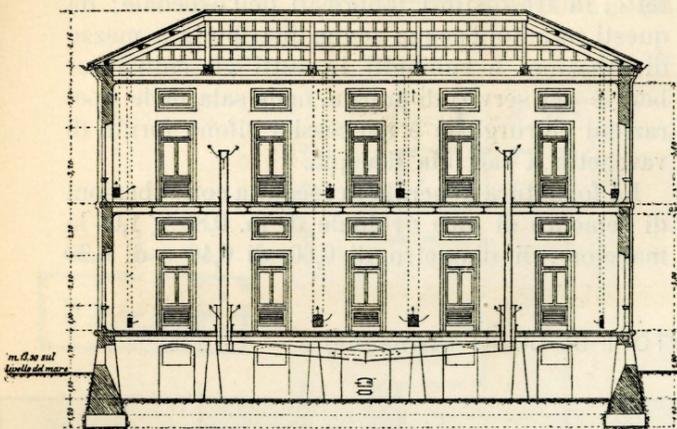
Sezione longitudinale di un padiglione a due piani colla disposizione del riscaldamento e della ventilazione.
